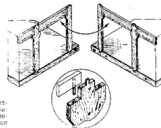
Установка и покрытие чашечки стержня в месте вертикального отрыва плиты от балки
